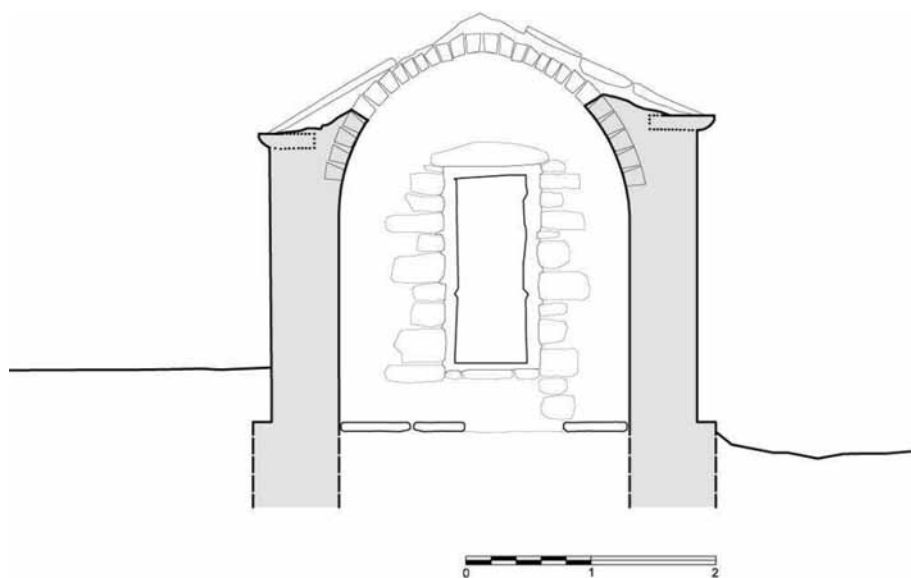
Изглед јужне фасаде цркве, прије радова
